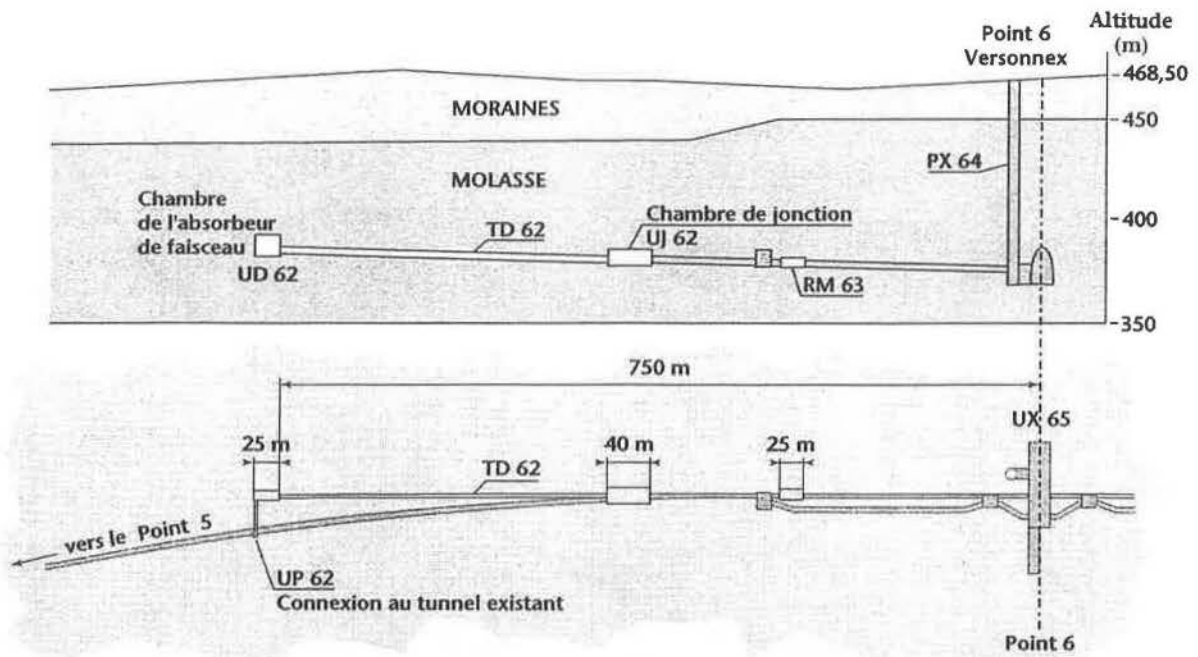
Situation et profil du tunnel TD 62 et de la chambre d'absorbeur UD 62
